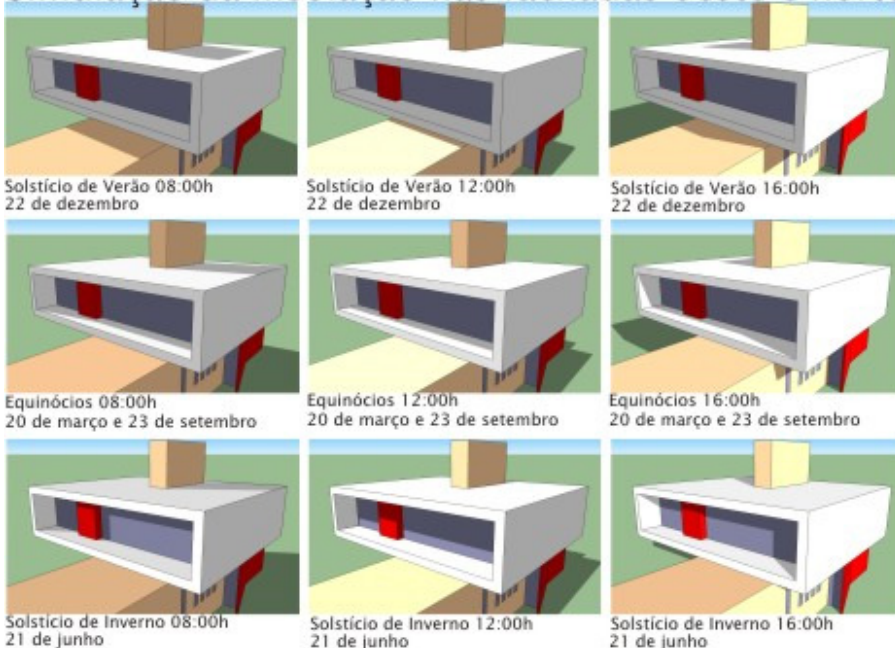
Projeto 1 - Simulação de insolação das fachadas leste e sul e das fachadas oeste e norte
